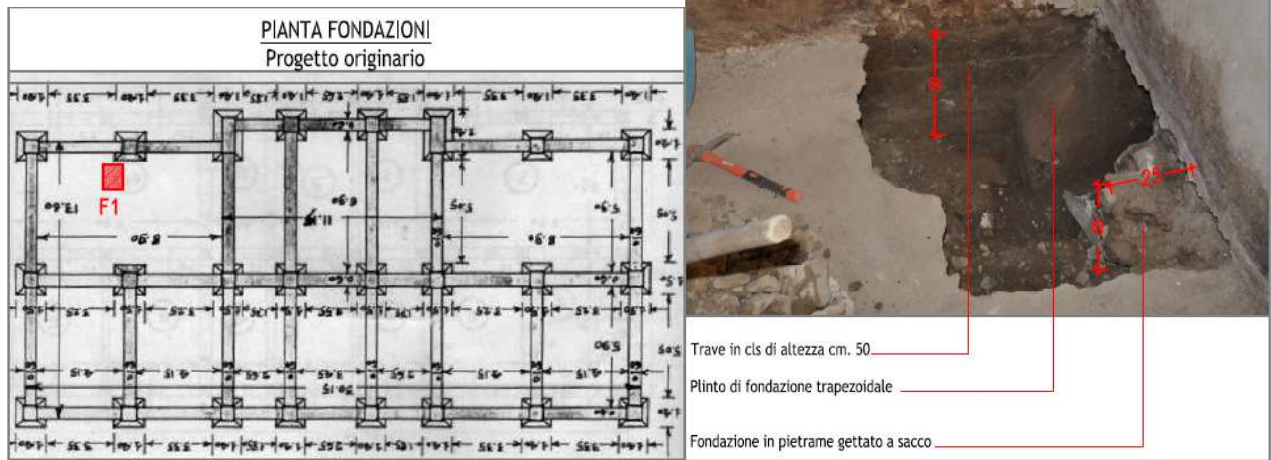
Stralcio del progetto dell'Edificio Comunale - Sezione plinto tipo e trave di fondazione.
